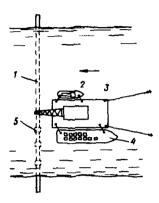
Схема установки грузов на подводный грубопровод 1— подводный трубопровод; 2— водолазный бот; 3— плавучий кран; 4— баржа с грузами; 5— грузы, установленные на трубопровод
